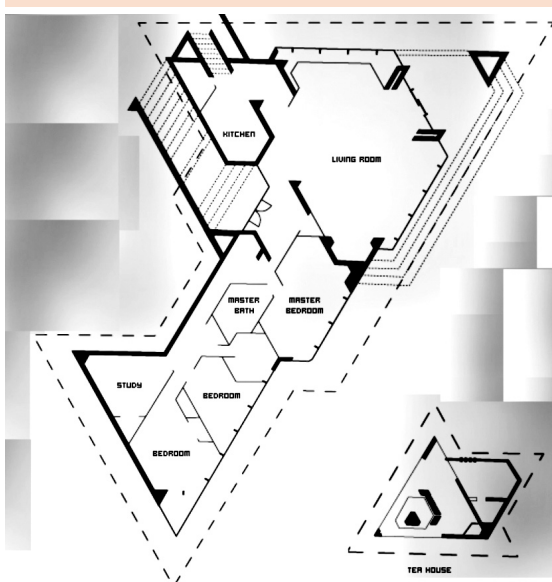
Planta da casa Palmer de Frank Lloyd Wright
